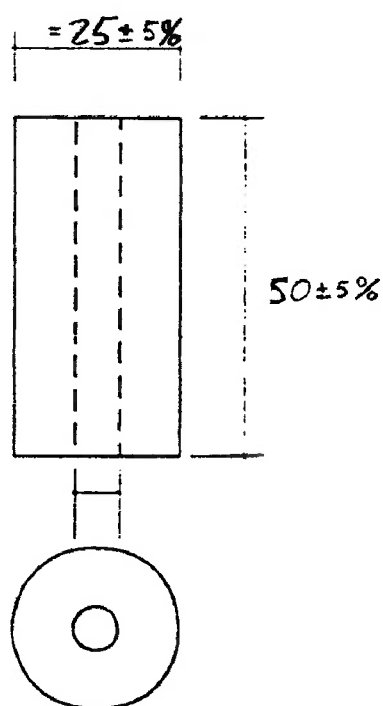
Dimensões do segmento de concreto (unidades em cm).
